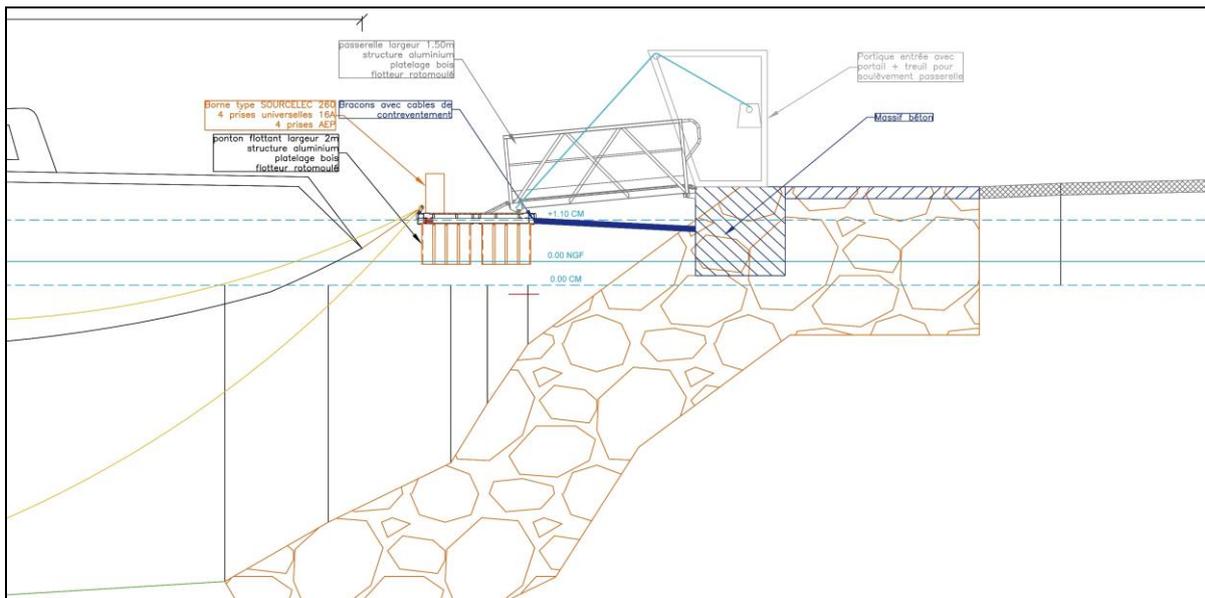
Coupe type du ponton flottant avec passerelle, portique et treuil
